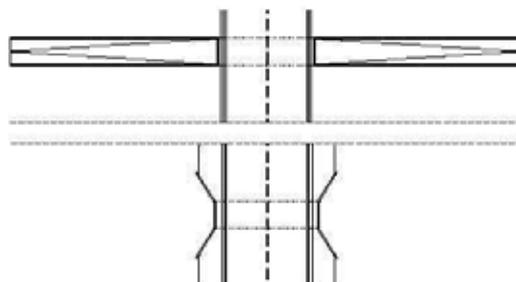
Figura PASO INFERIOR PARA PEATONES. DISPOSICIONES RECOMENDADAS EN PLANTA.
